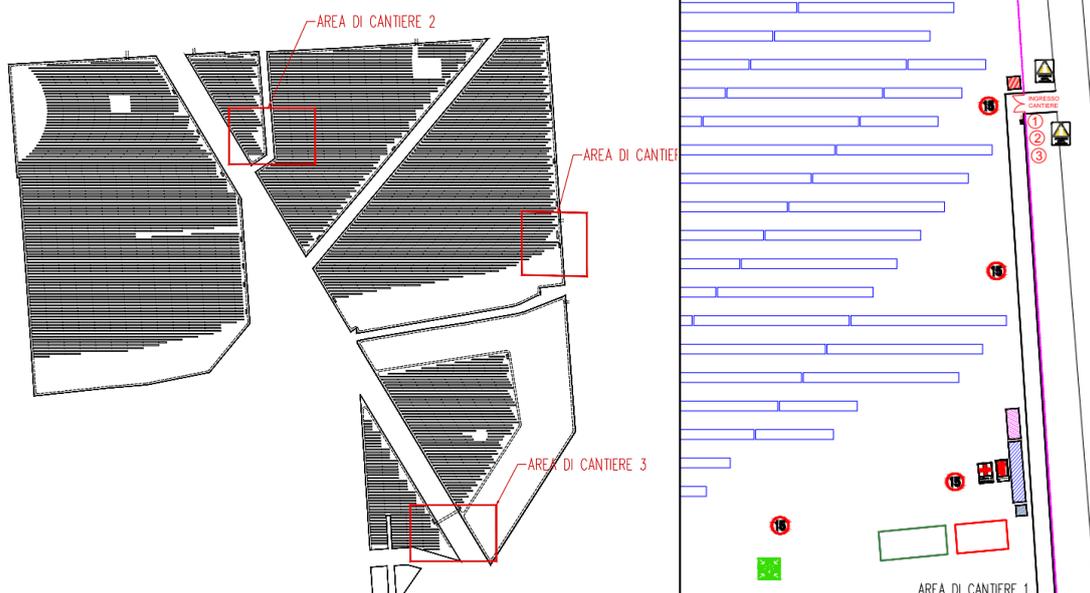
Estratto elaborato E-20 - PLANIMETRIA DI CANTIERE
